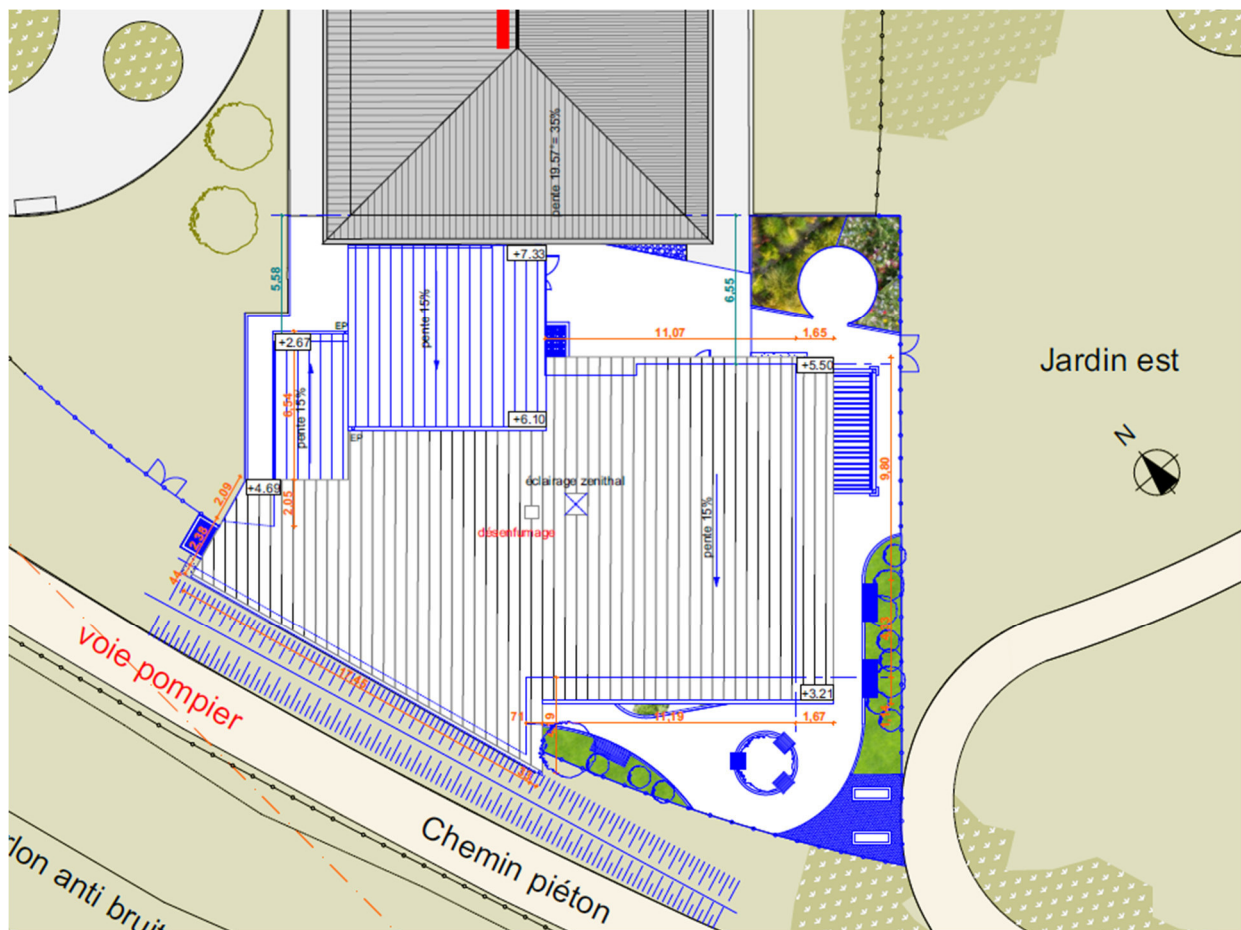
Extrait du plan de masse du projet d'extension, CETEL
